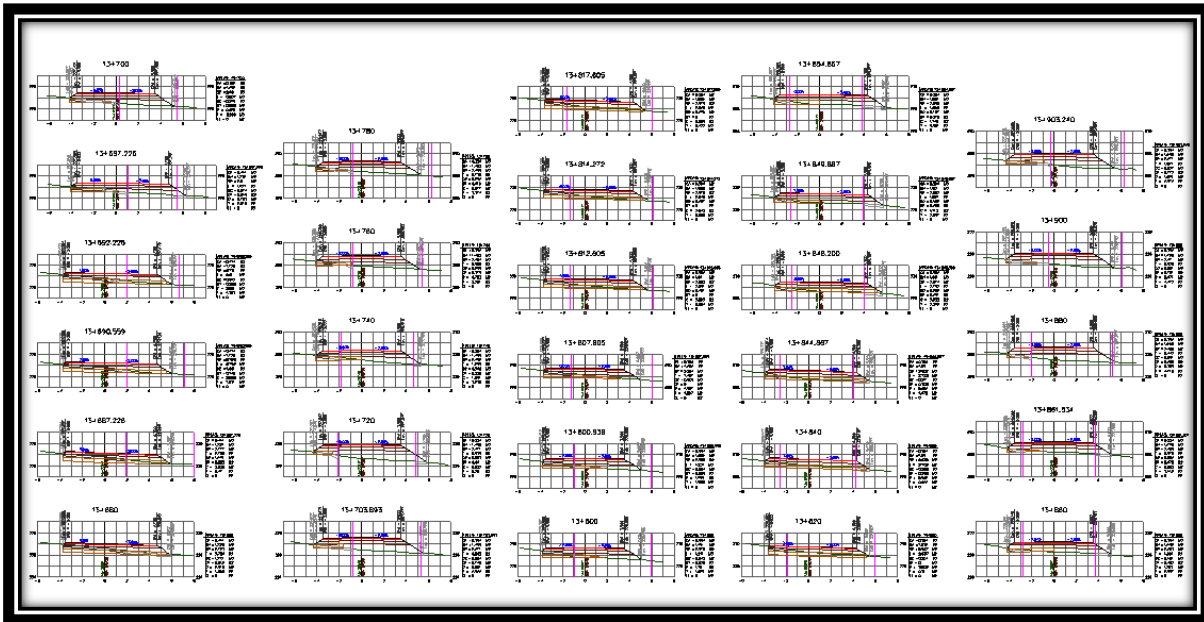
Secciones de construcción del km 13+680.000 al km 13+903.240.
